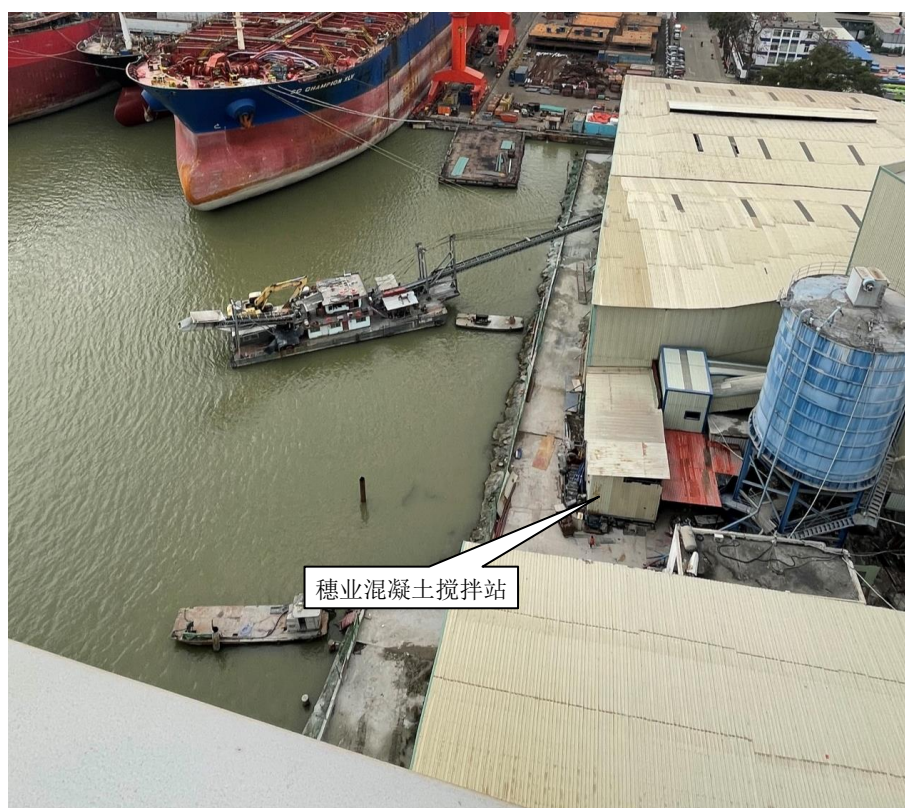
广州穗业混凝土有限公司混凝土搅拌站现状照片
